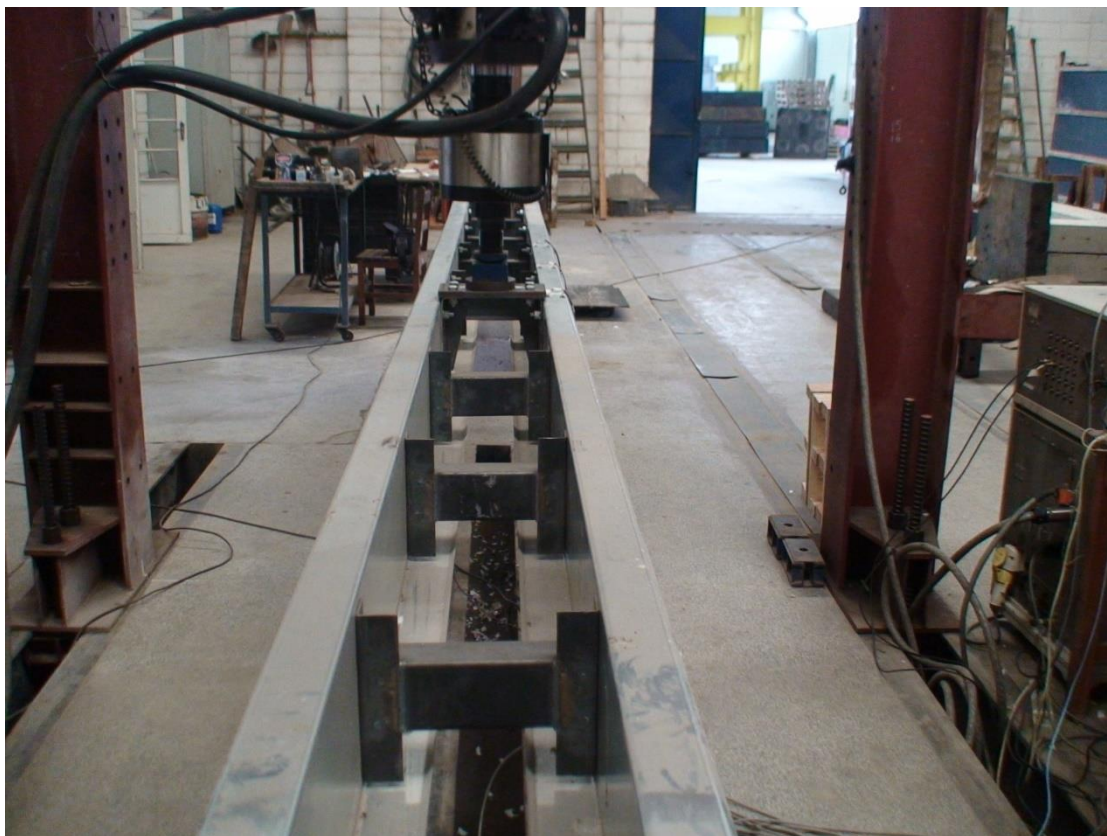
Detalhe dos intertravamentos laterais para evitar instabilidades globais.
